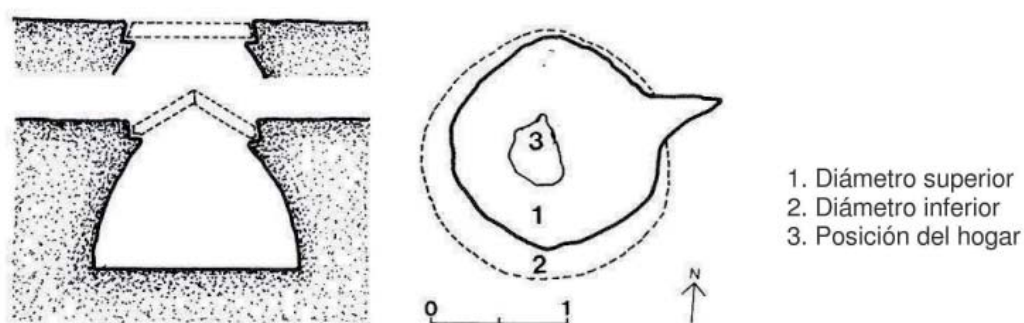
Izqda: Sección vivienda del neolítico excavada en “saco” con dos hipótesis sobre la forma de cubierta temporal. Dcha: Planta de una vivienda excavada en “saco”. Pueblo de Jing. Provincia de Shanxi, China. (Fuente: LOUBES, J.P: *Arquitectura subterránea. Aproximación a un hábitat natural*. Pág. 20).
